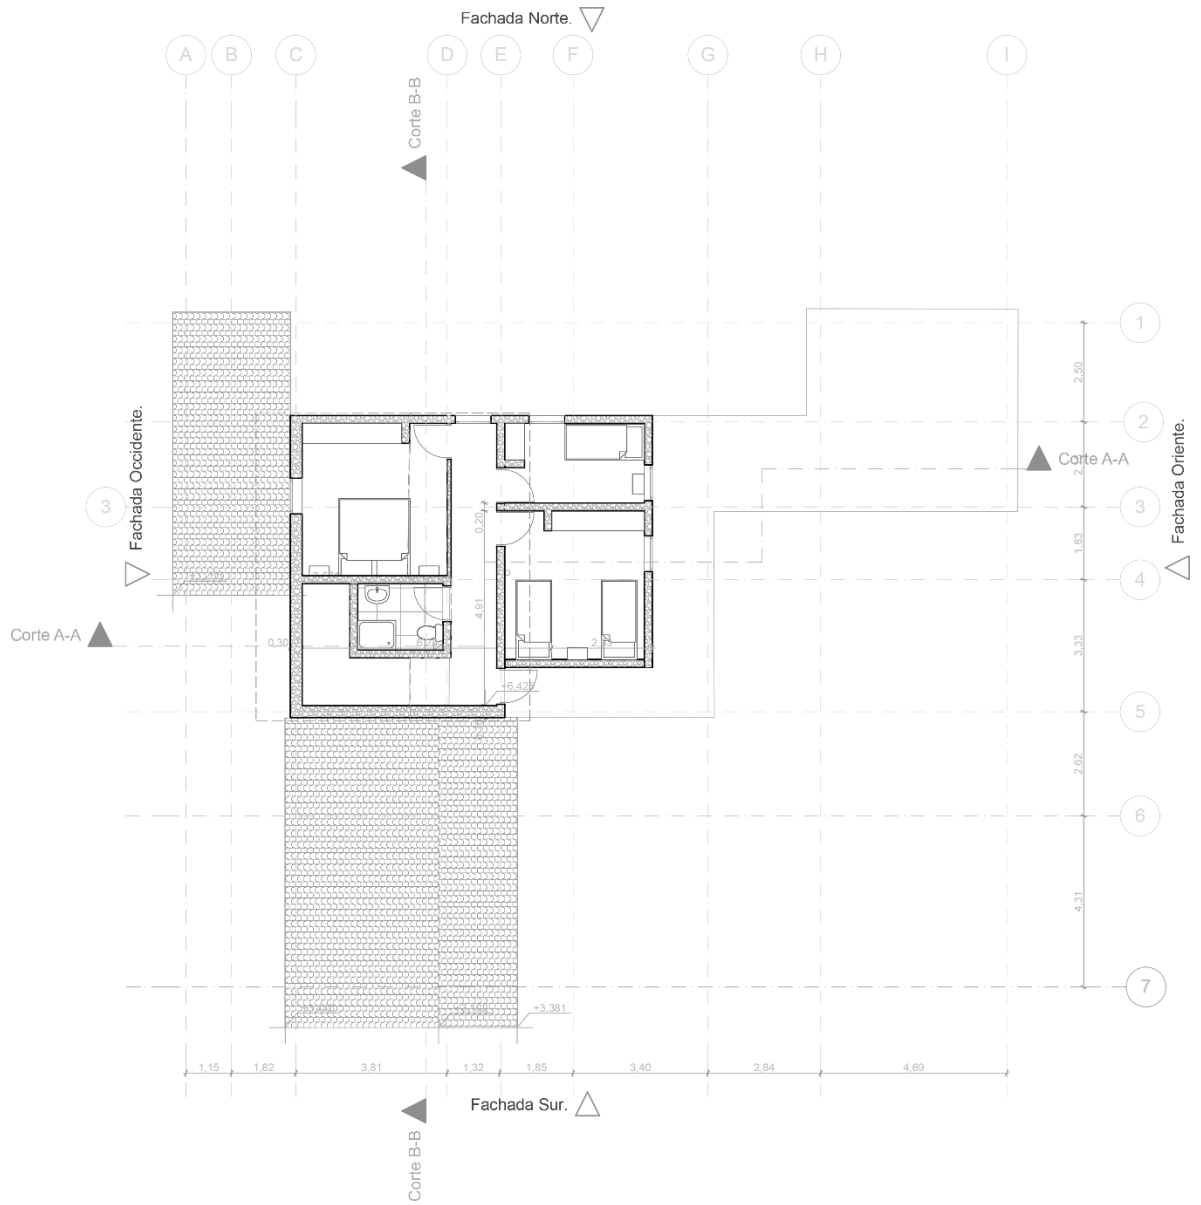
Planta Arquitectónica primer piso, Prototipo de vivienda rural.
